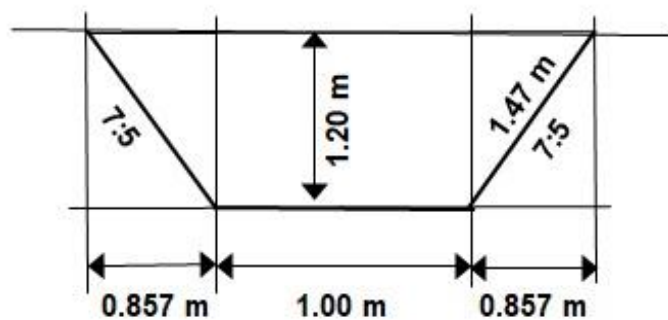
; Ausschnitt aus Plan Haltungen Generellen Entwässerungsplanung (GEP) Berechnung (ohne Massstab)
